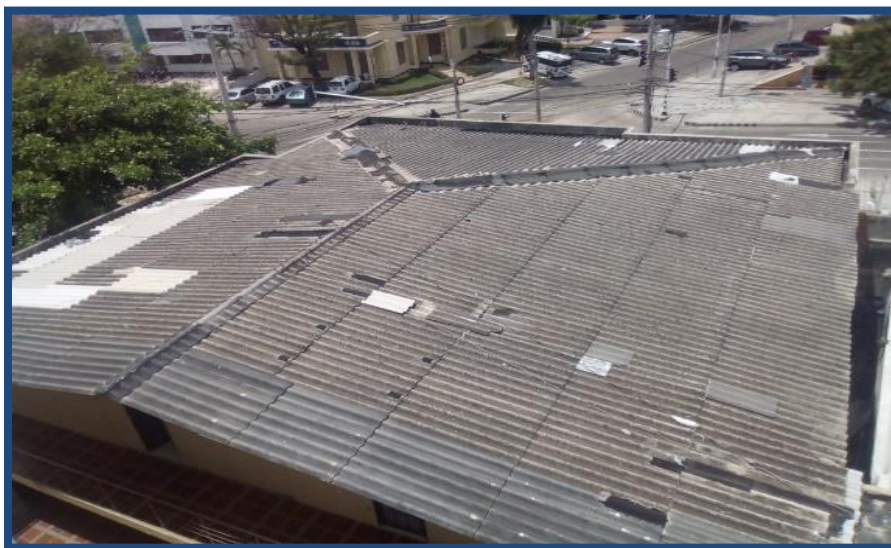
Cubierta edificio #1. Fuente: Propia
